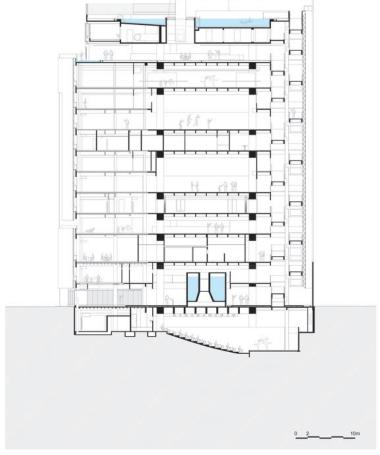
Corte AA SESC 24 de Maio, Sao Paulo. Fuente: Mendes da Rocha + MMBB Arquitectos.
